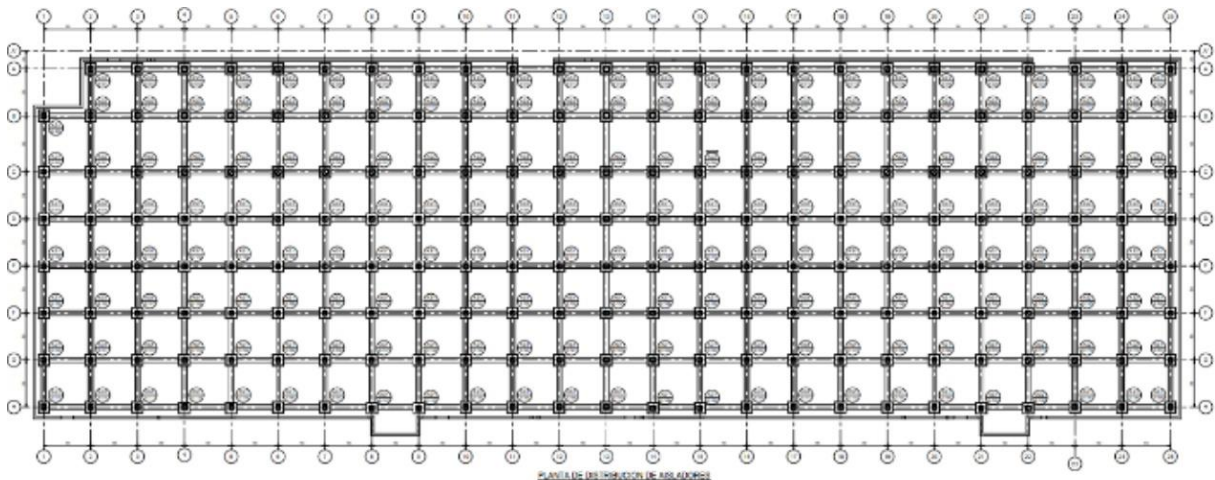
Estructura bajo aislamiento del Hospital de Parral.
